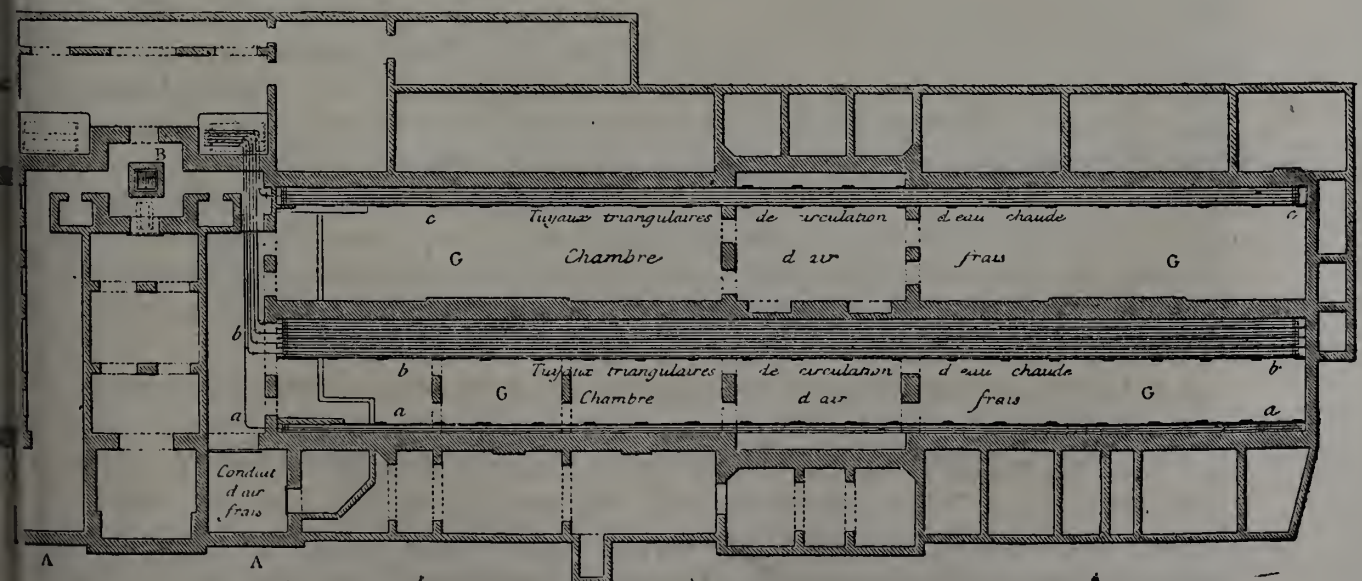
Plan du sous-sol (suivant CD de la coupe verticale) contenant l'appareil à eau chaude.
